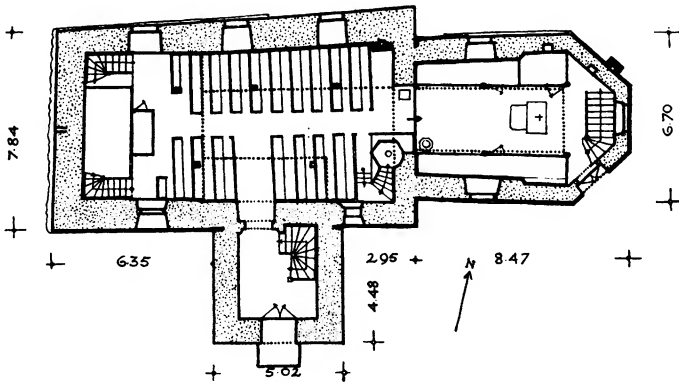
Dessau—Törten. Grundriß der Kirche (Maßstab 1:300)
